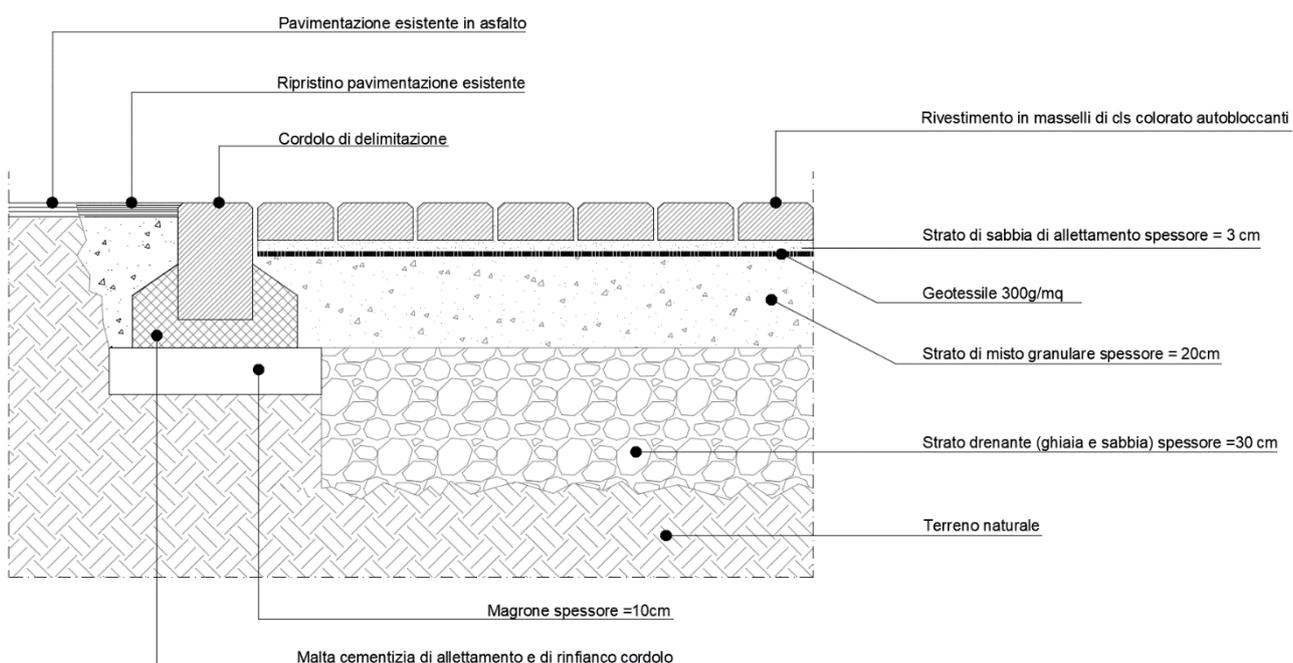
Stratigrafia pavimentazione drenante del piazzale
